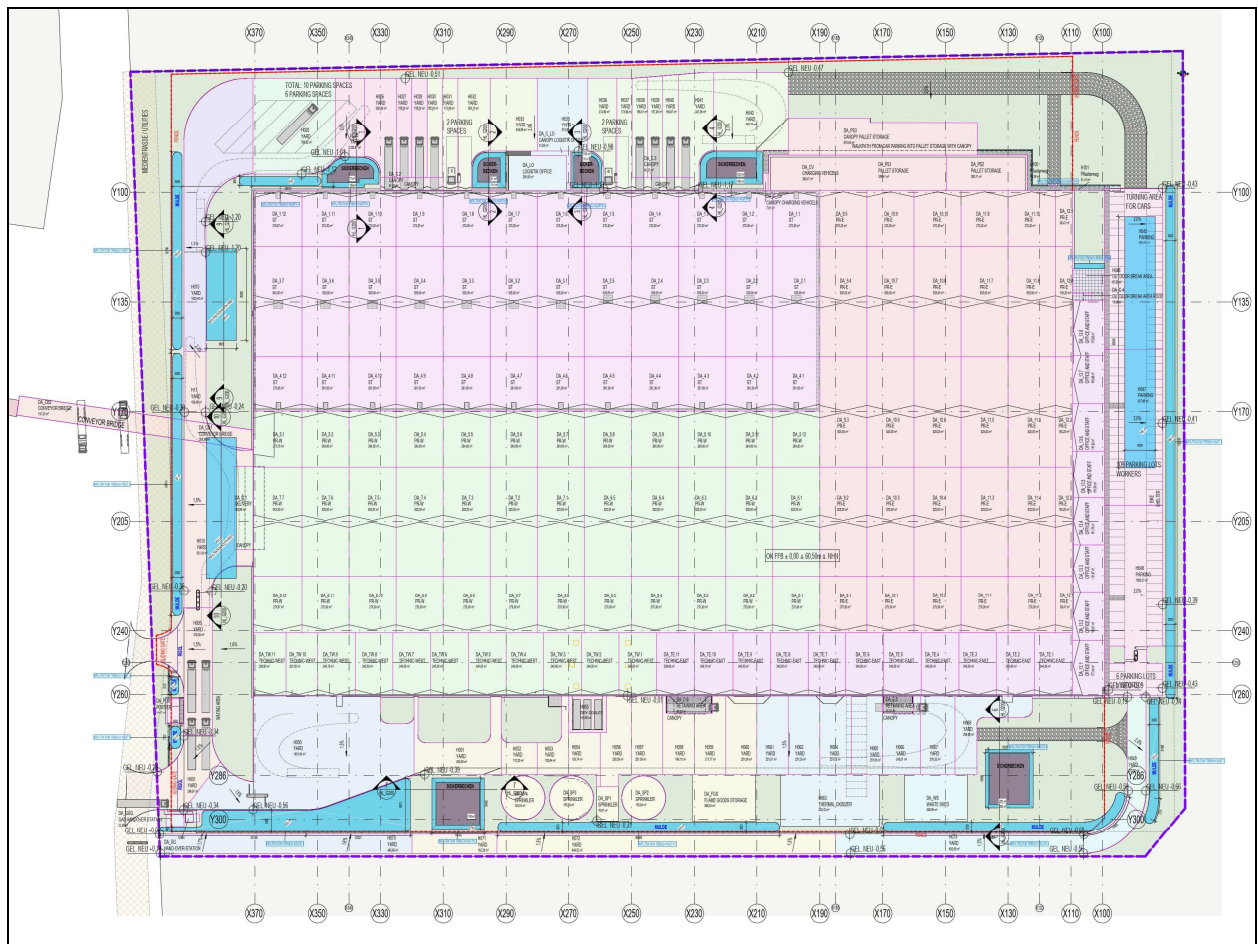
Plan der befestigten und Dachflächen einschl. Versickerungsanlag. Stand Feb. 2026 [3]
